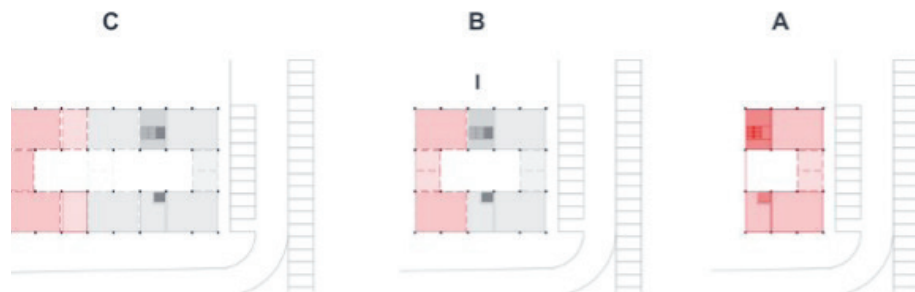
Grundriss Erdgeschoss mit Umgebung
